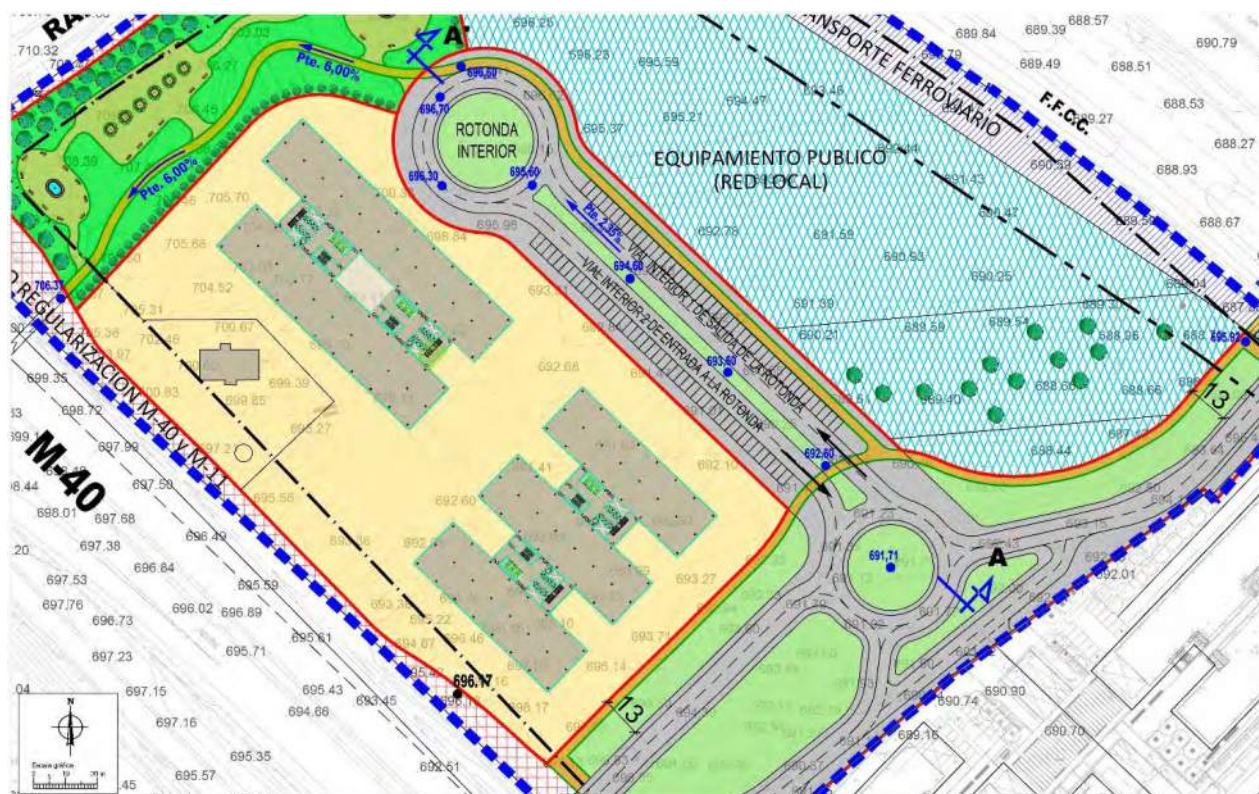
Detalle del Plano P.I.6 – Propuestas indicativas del PPRI
